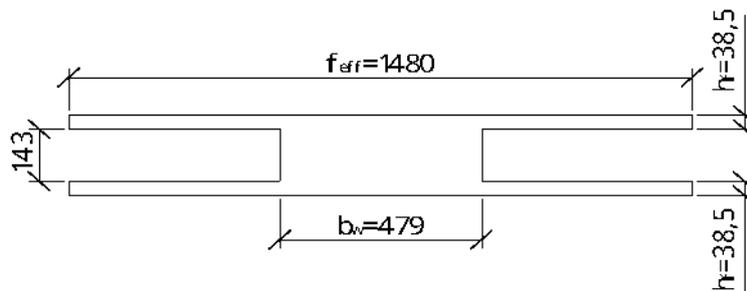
Приведений переріз багатопустотної плити до двотаврового
